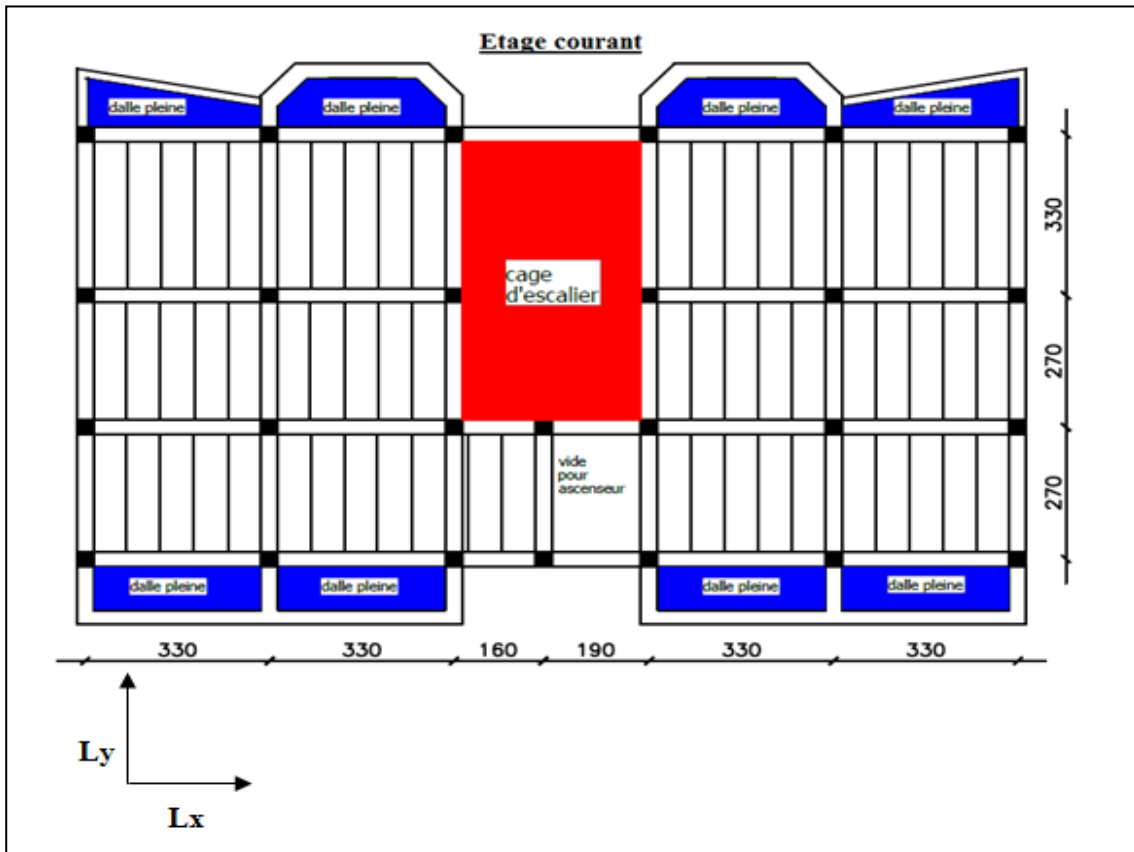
Plan de disposition des poutrelles (Etage courant)
